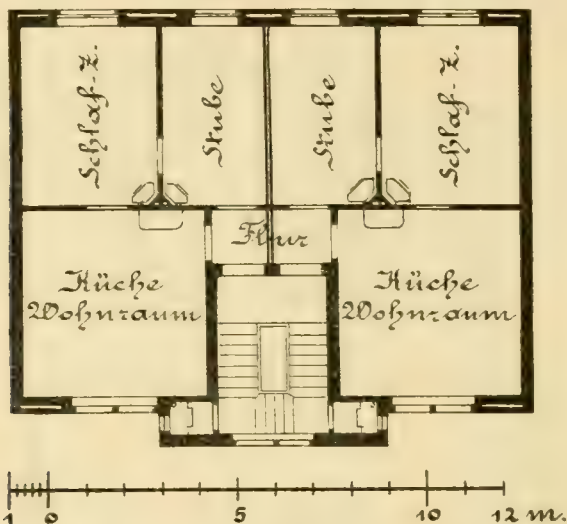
Plan eines Arbeiterwohnhauses. Grundriss der Obergeschosse.
